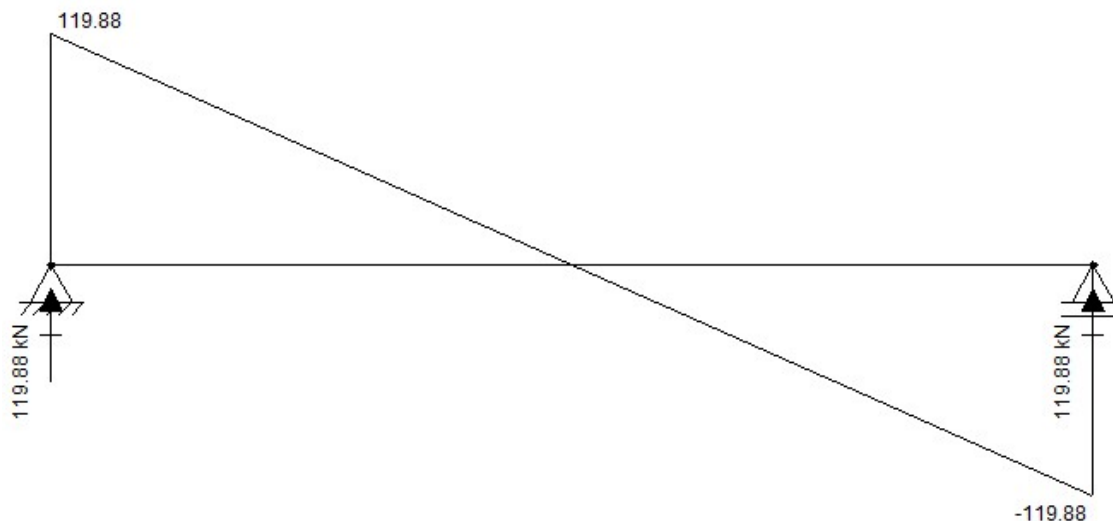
Reações de apoio da viga V2 do teto do 3º pavimento
